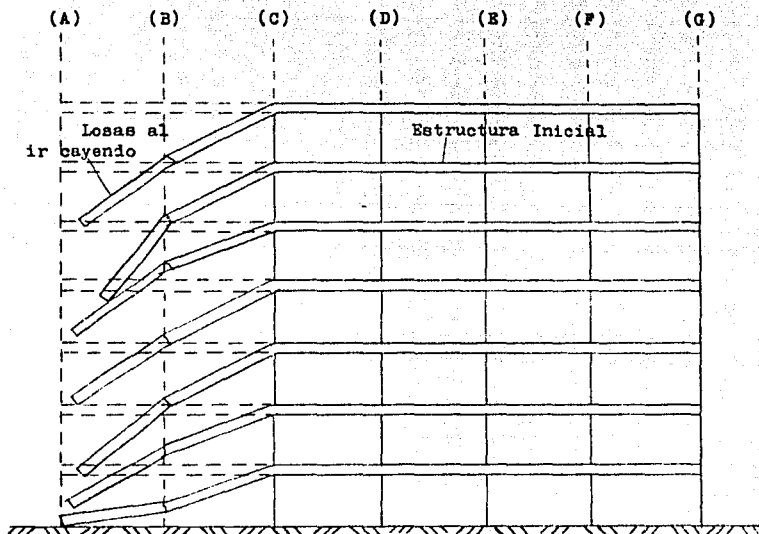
Fracturación de Losas al ir Cayendo la Estructura, al Demolirse Primero las Columnas del Eje (A)
